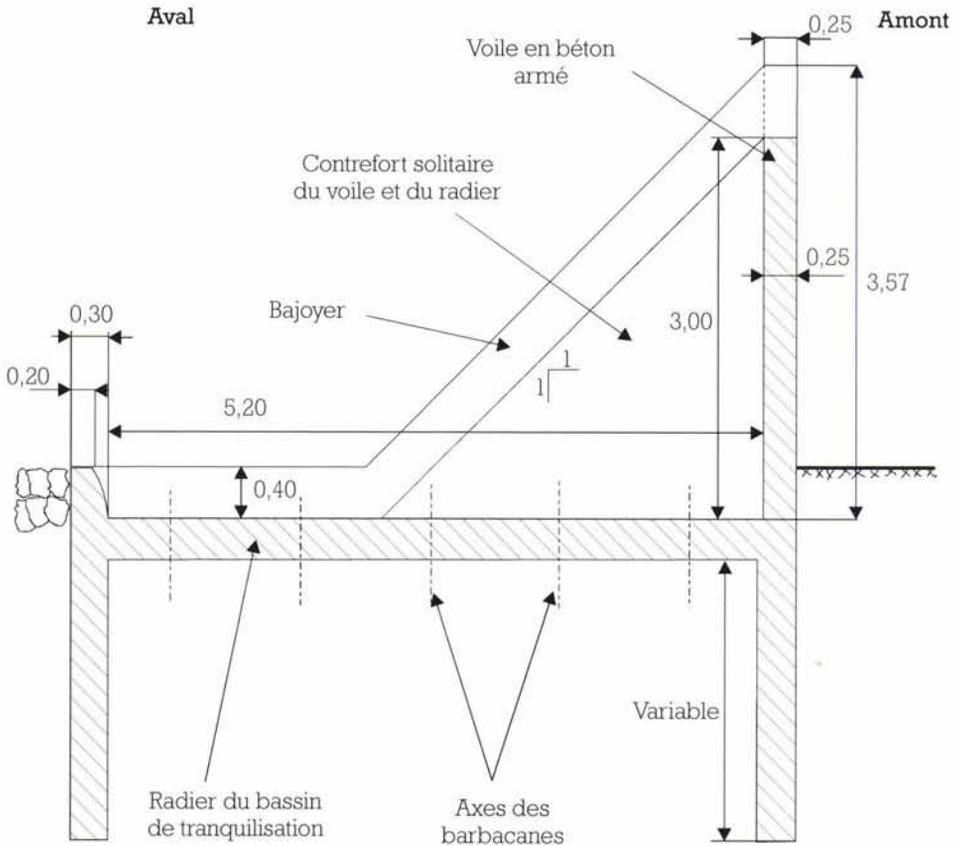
D-1 : Coupe schématique du barrage de Balavé (vue en direction de la rive droite).
